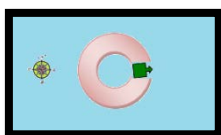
Planta de la atalaya del Zambullón. Sin escala. Elaboración propia.
